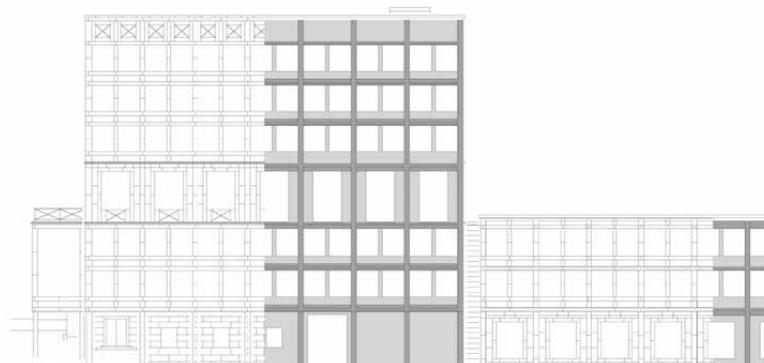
Fassadenansicht mit Plattengliederung (links) und Konstruktion (rechts)
